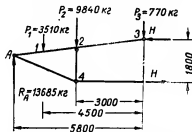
Определение усилий в нижнем поясе фермы.
